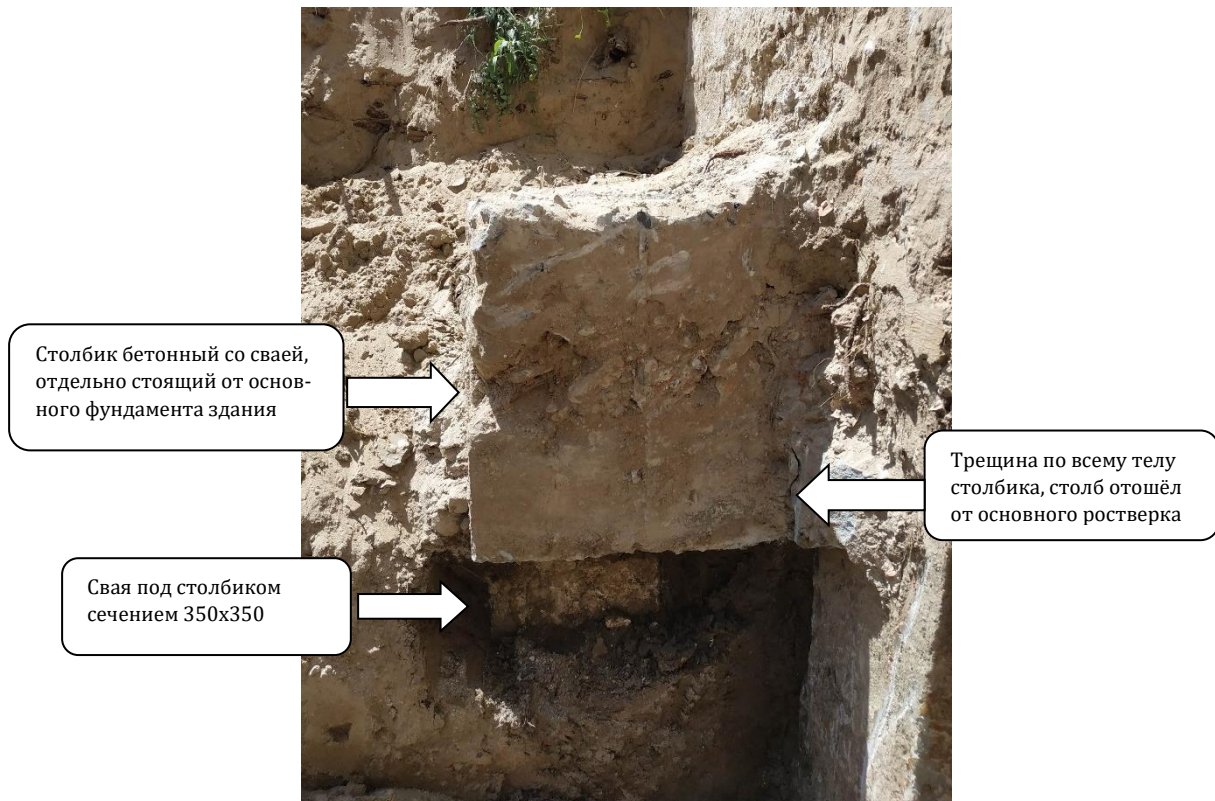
Фото фиксация бетонного столбика со свайей, отдельно стоящего от основного фундамента здания
